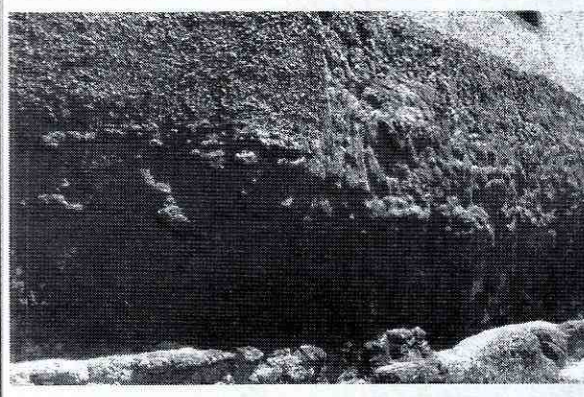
Agrietamientos en la base del muro del costado sur.
